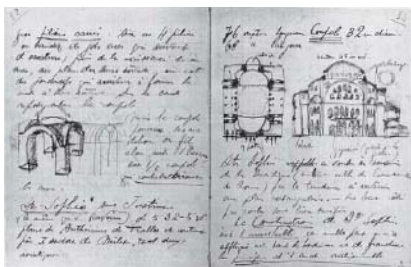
Dibujo de la planta y sección de Santa Sofía. Fuente: FLC.A2 19134-135
